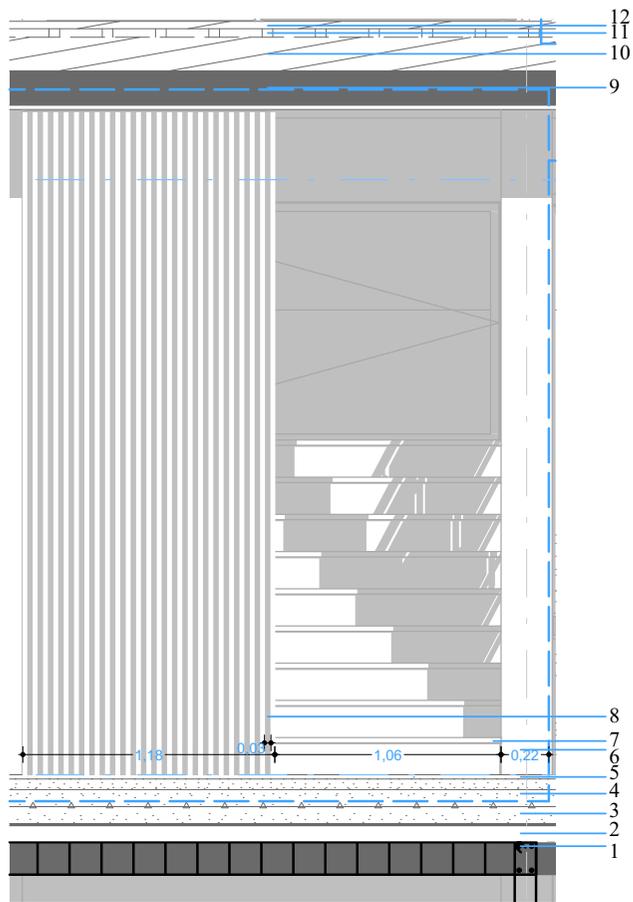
Detalle constructivo sección 2. Fuente: Autora.
